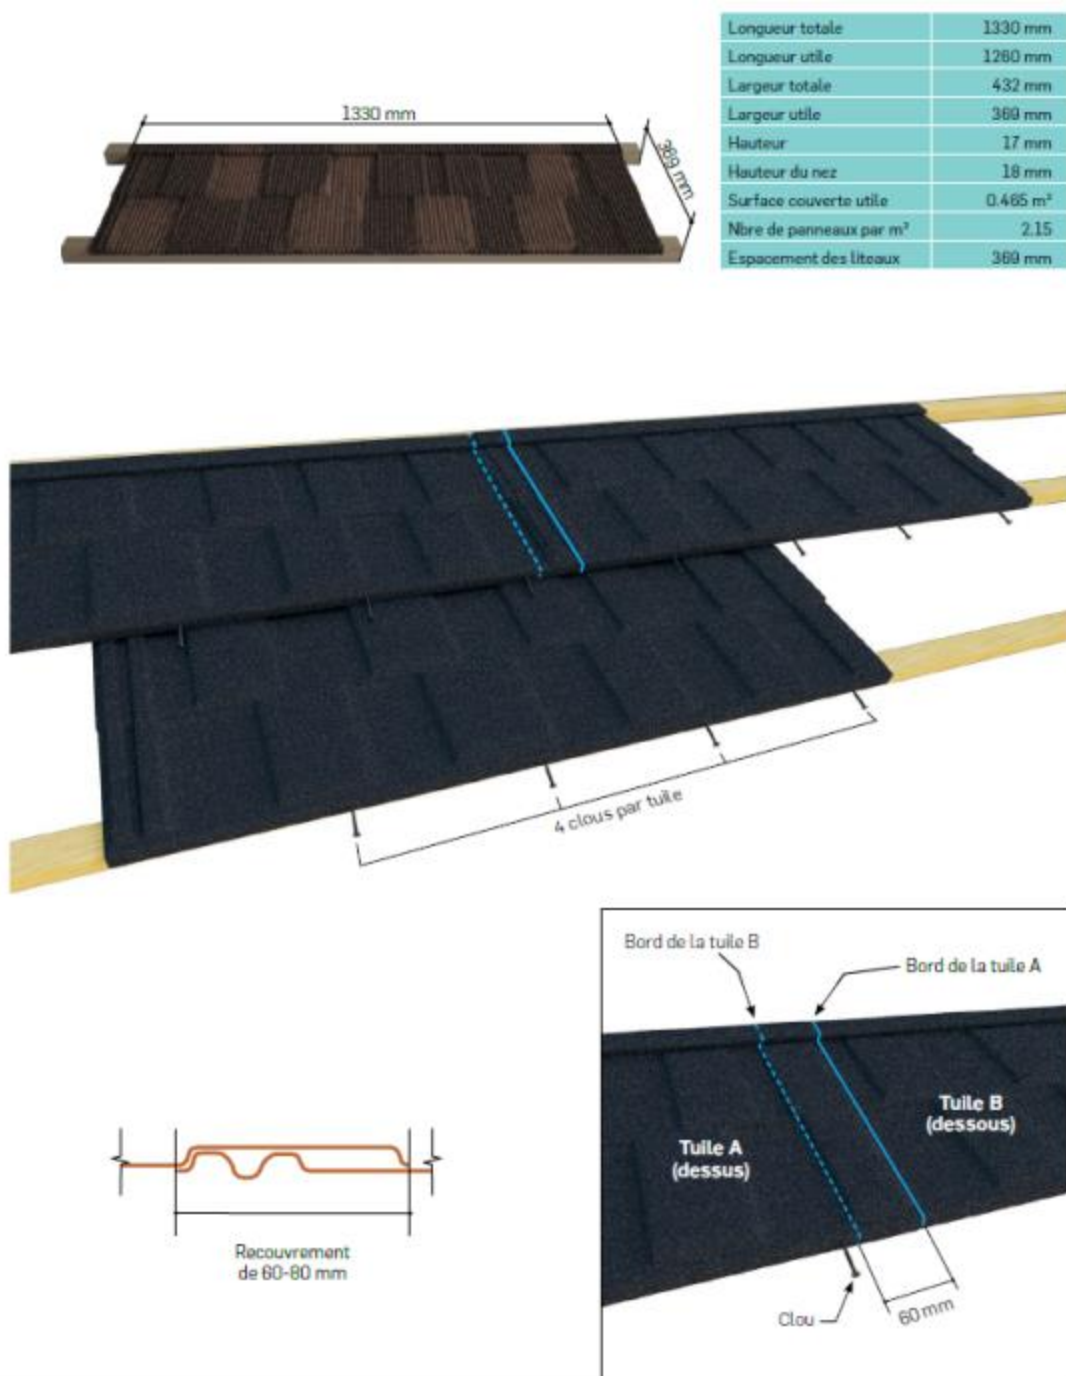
Tuile « GERARD SENATOR », dimensions, clouage et recouvrement
